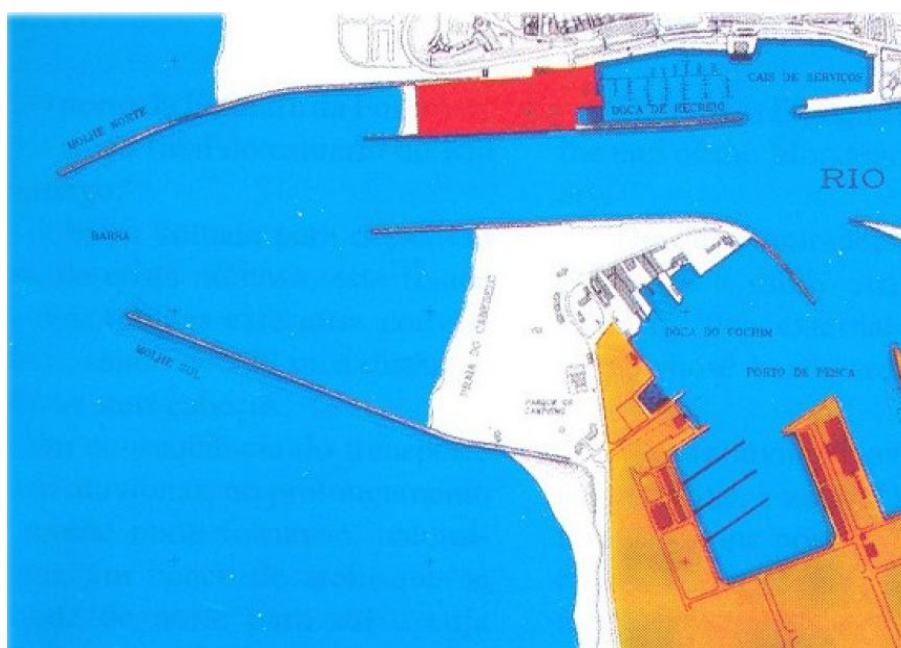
Planta do porto da Figueira da Foz. [2]
